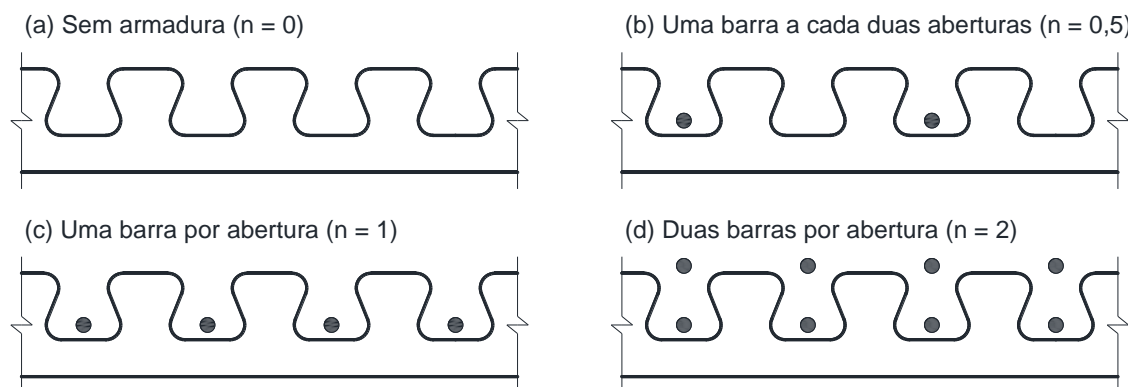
Distribuições de armadura transversal nas aberturas do conector Crestbond.
